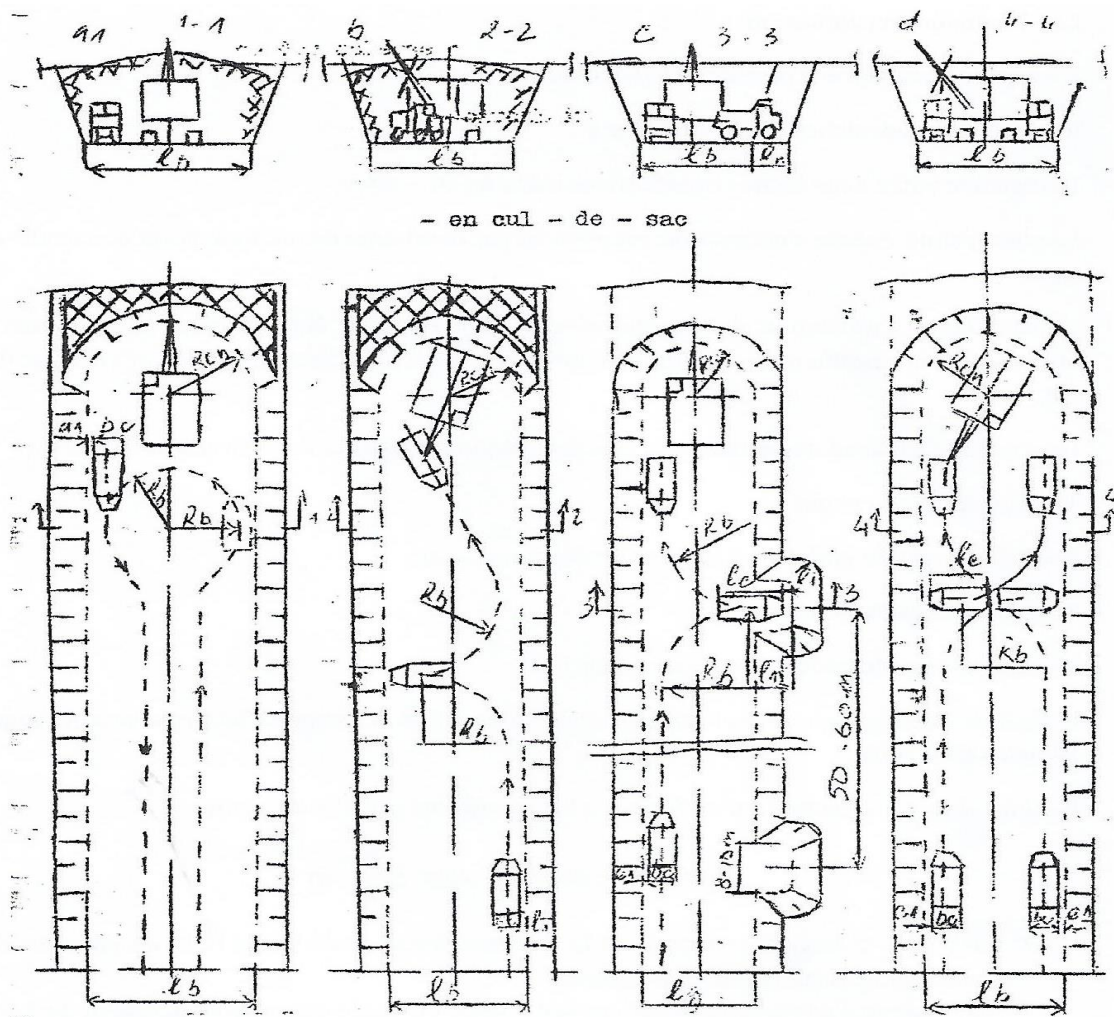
Excavation des tranchées avec camions placés au niveau de l'excavateur
